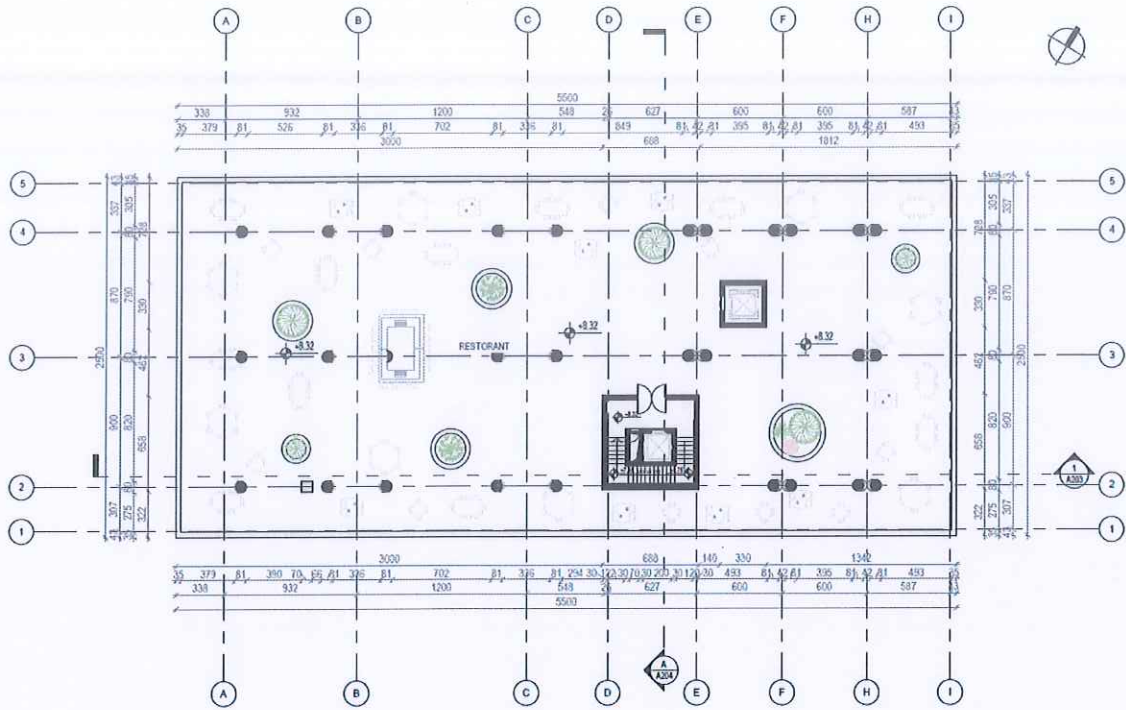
Planimetri “Stacioni Multimodal” – Kati 2
